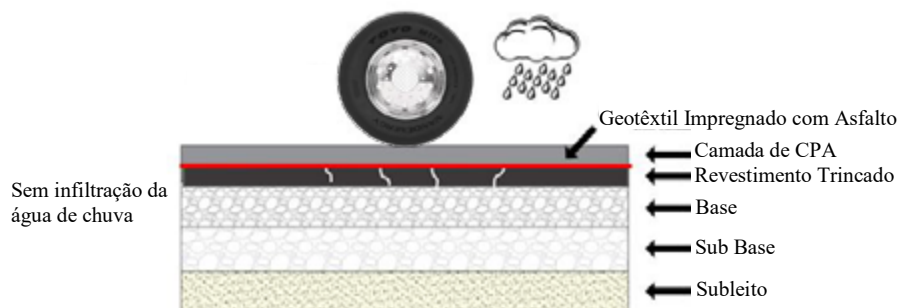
Impermeabilização da estrutura do pavimento com geotêxtil impregnado.
